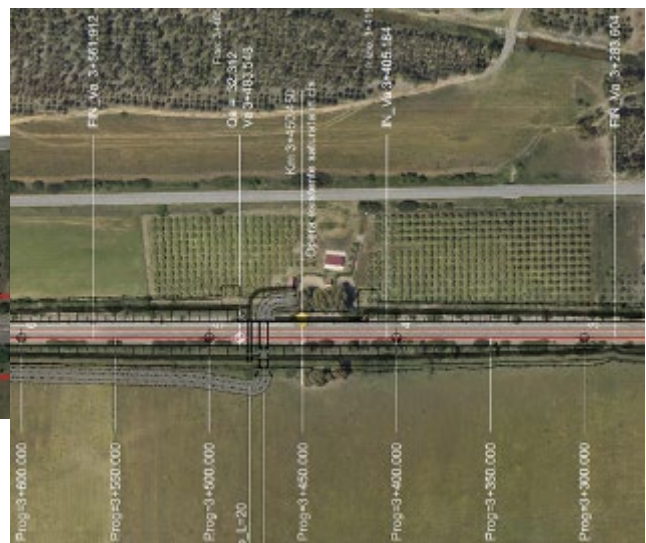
Dettaglio della planimetria di progetto nell'area di interferenza con le piante di olivo
